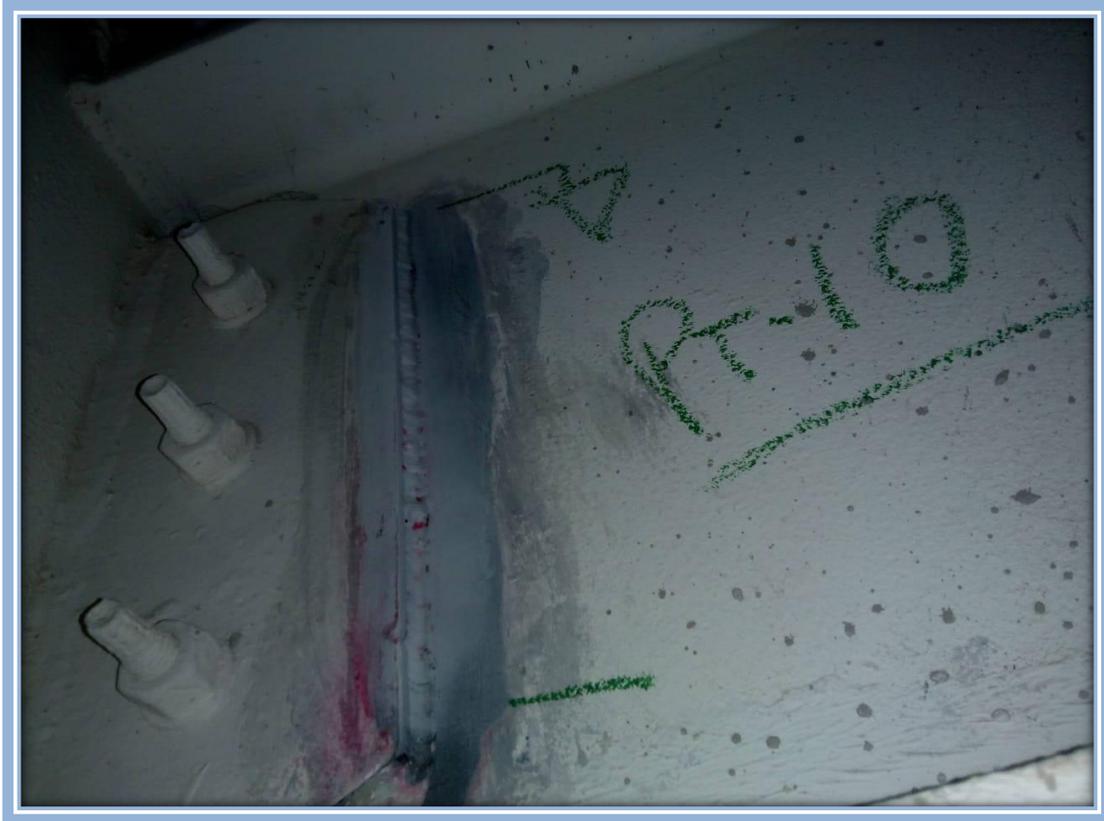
Líquido penetrante en columna eje o-17, indicando las imperfecciones superficiales de la soldadura en color rojo.
